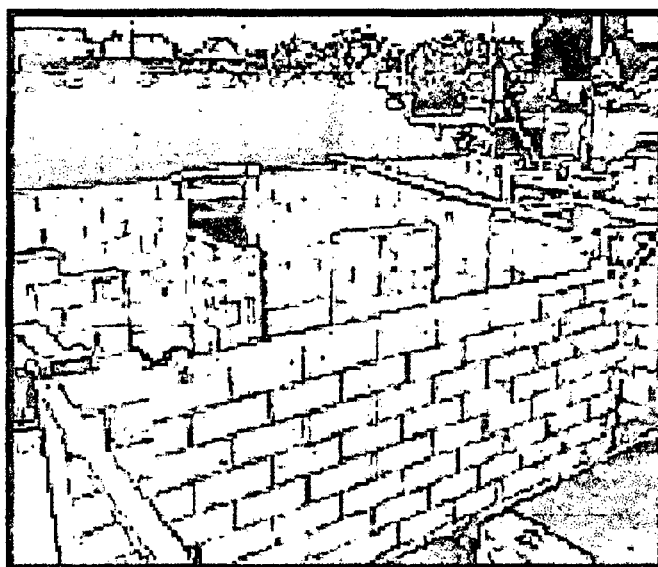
Construcción de un muro con bloques de concreto aireado.
